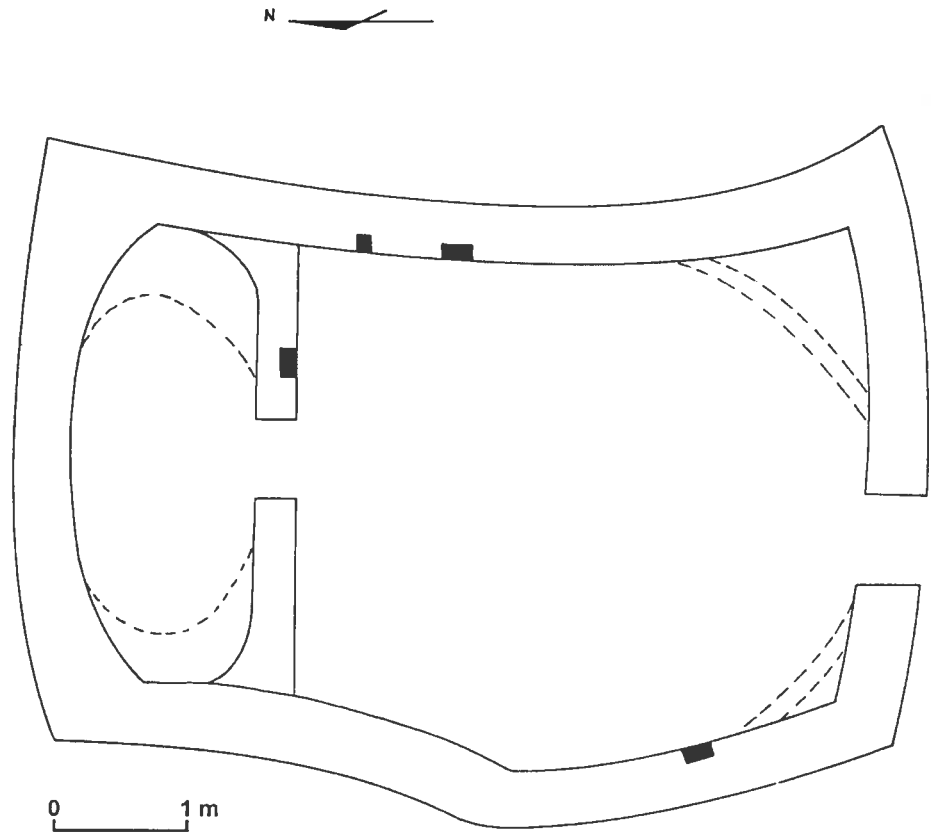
Plan de l'habitation B de type Rapayan à toit plat du secteur II du site # 43 de Wata, zone de Singa.
